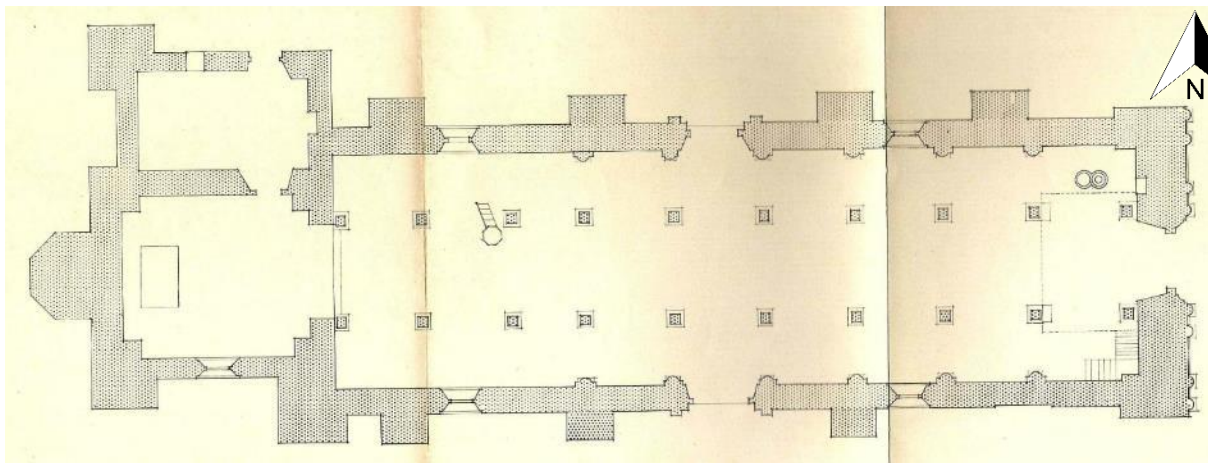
Planta arquitectónica de Iglesia La Asunción, planos diciembre 1965.
